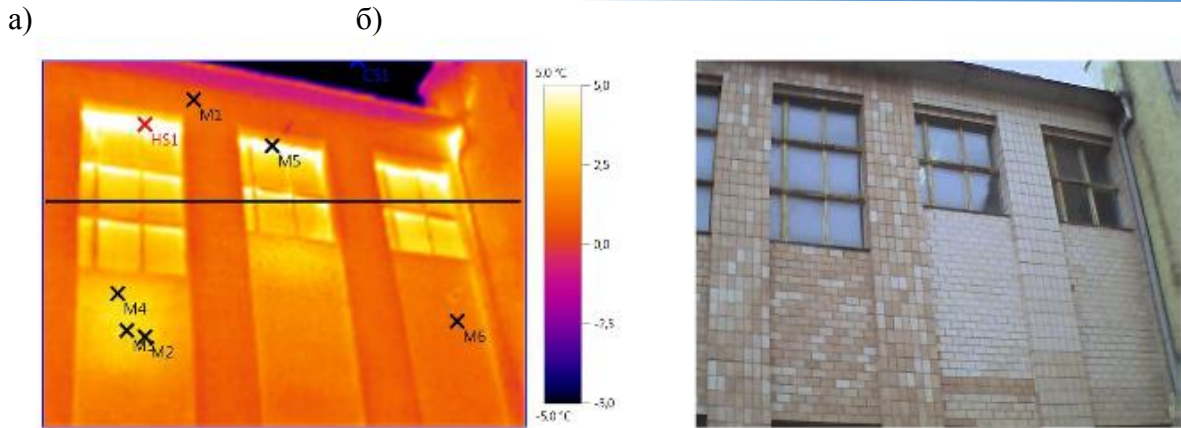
Фасад 1 – 10. Вікна лекційної аудиторії: а – зйомка тепловізором; б – фрагмент фасаду.
